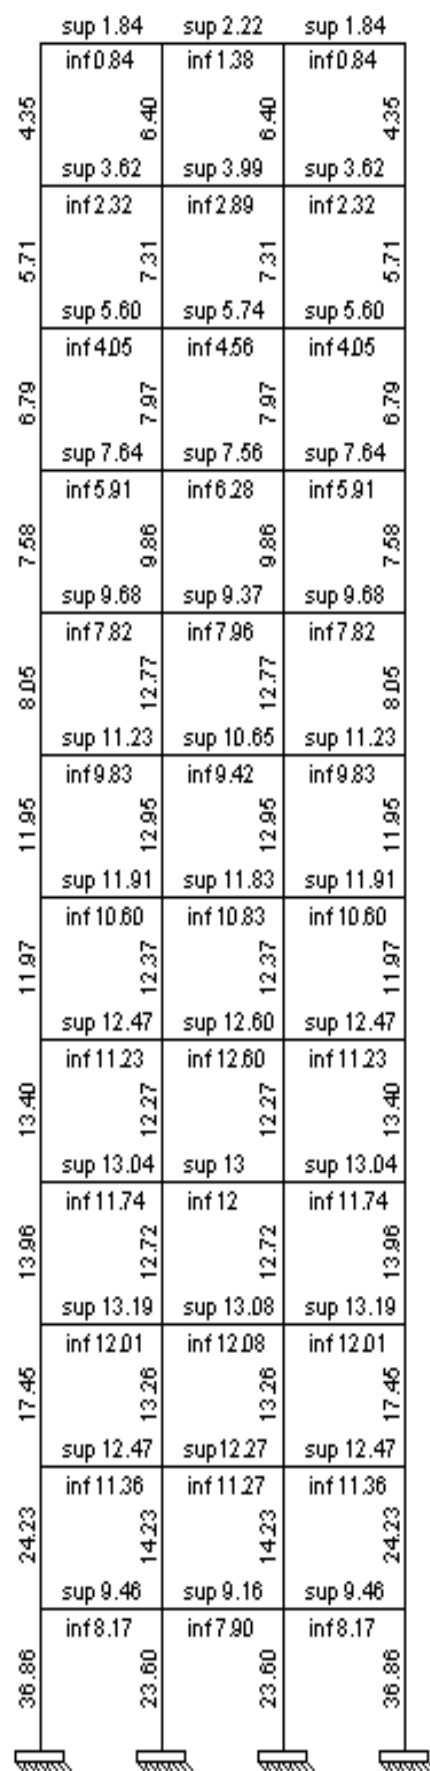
Figure VII : Ferraillage (cm<sup>2</sup>) du portique de la coupe AA (sens XX) bâtiment 01.
